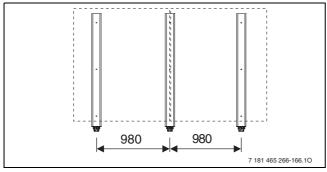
Grundausführung für 2 senkrechte Kollektoren
